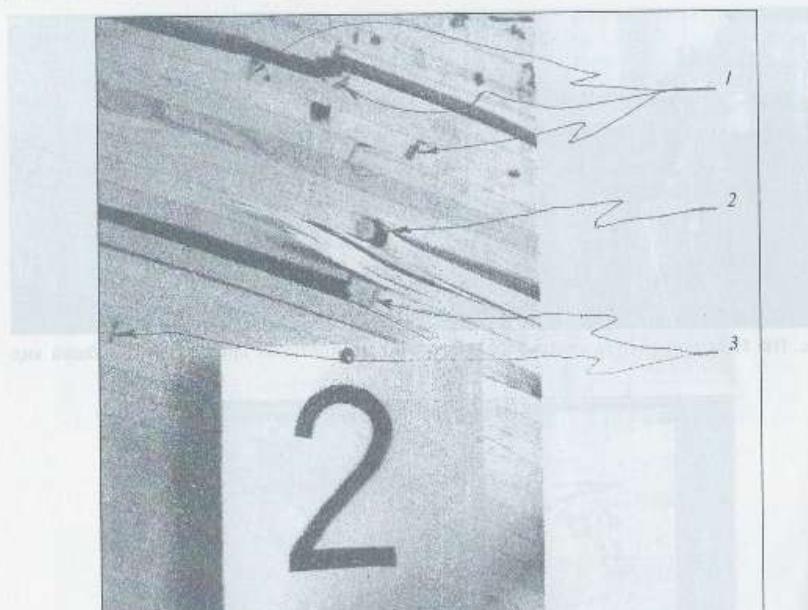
Трещины в растянутой зоне гнуто-клебных рам (ДГР)
